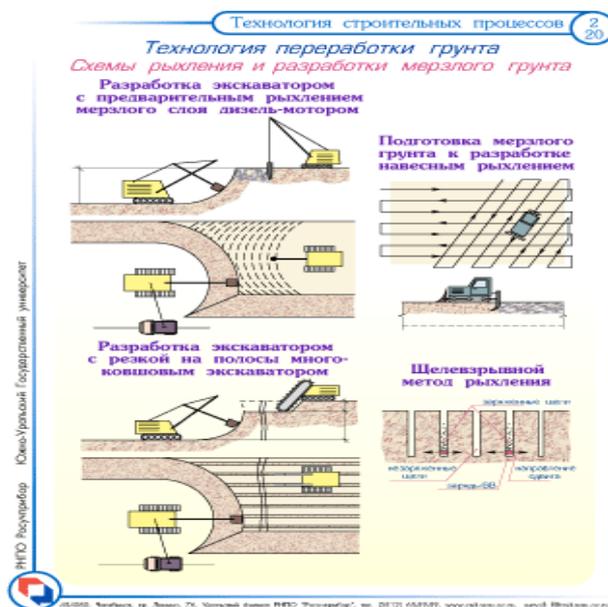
Схемы рыхления и разработки мерзлого грунта
